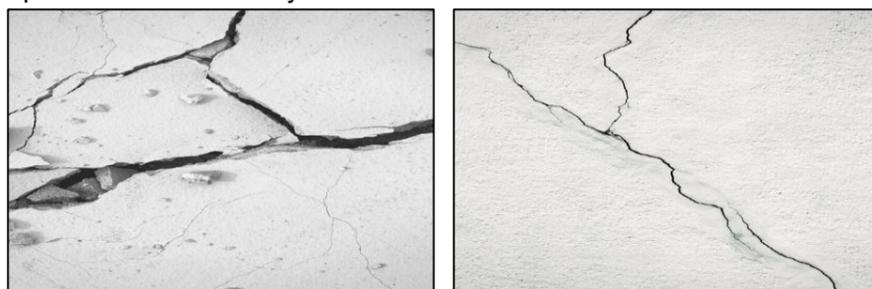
Grieta y Fisura (Google imágenes)
